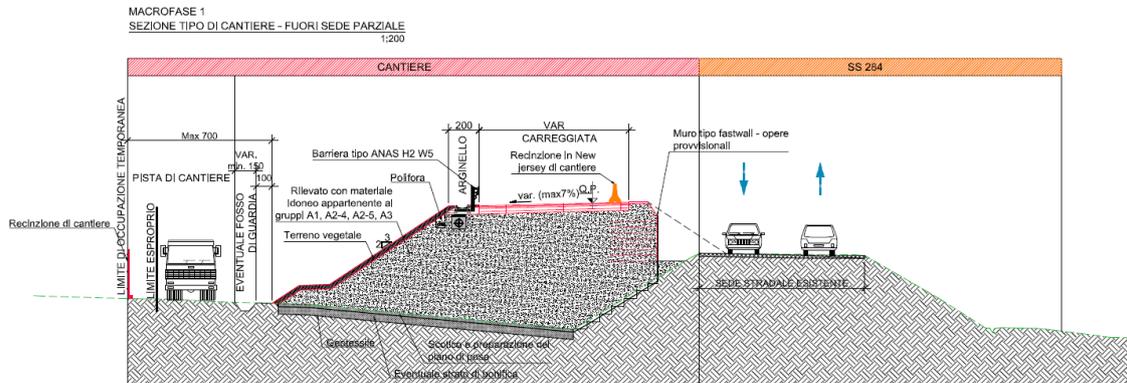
Intervento Fuori Sede Parziale (F.S.P.) – MACROFASE 1 - Sezione trasversale tipologica di cantierizzazione
